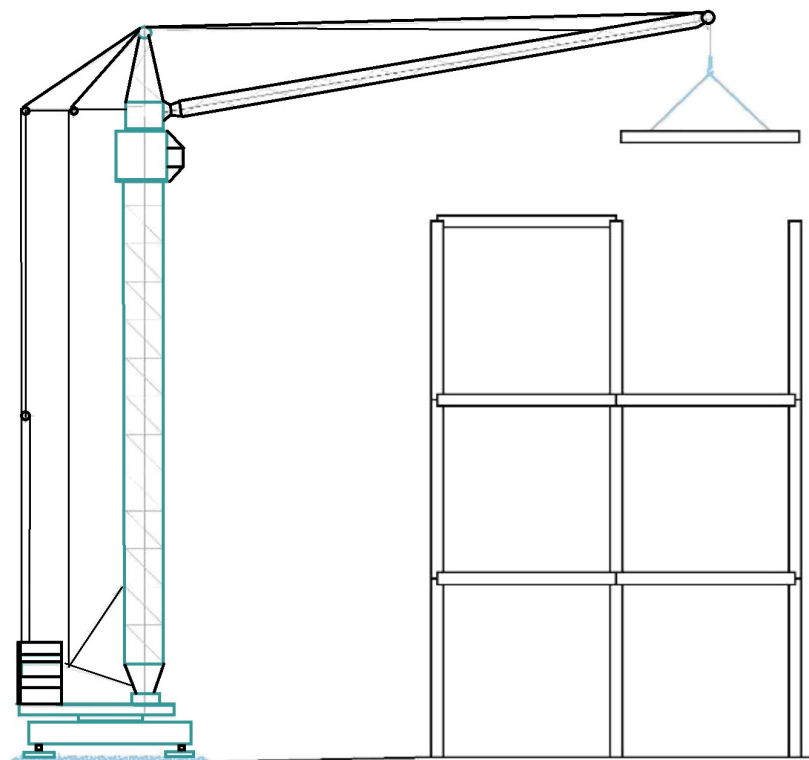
Монтаж балок краном при новому будівництві
